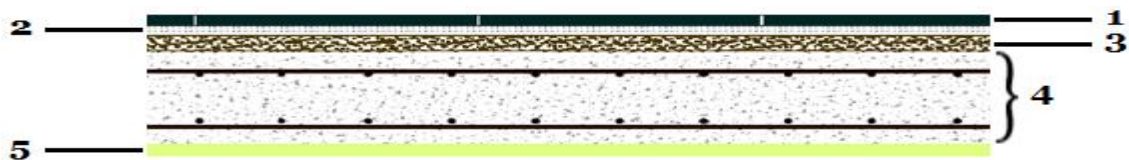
Coupe transversale d'un plancher à dalle pleine
